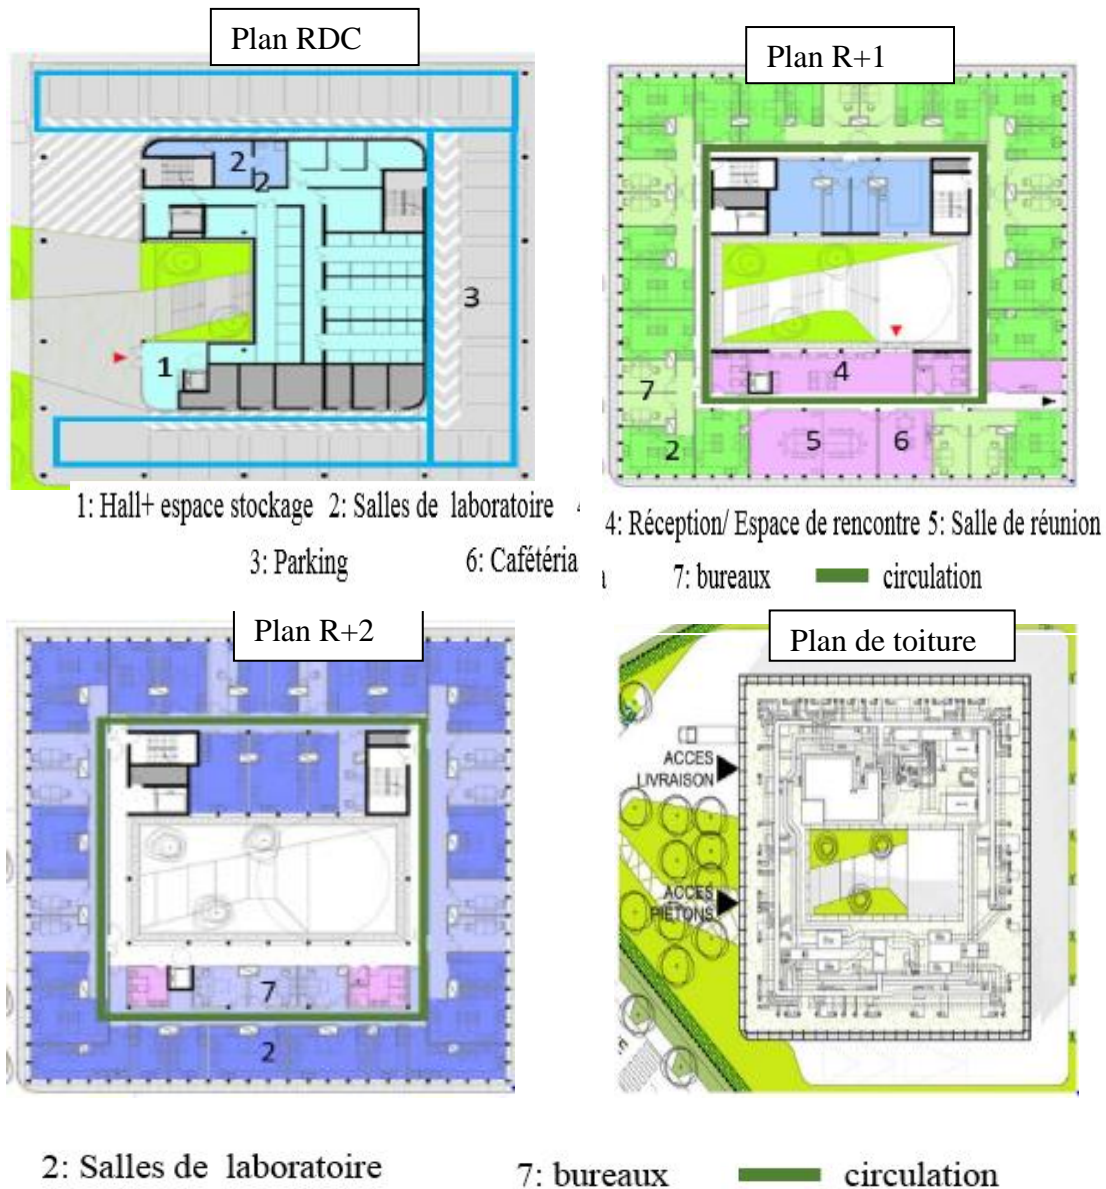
Analyse fonctionnelle plan R+2 et plan de toiture. Source : Arch Daily.
